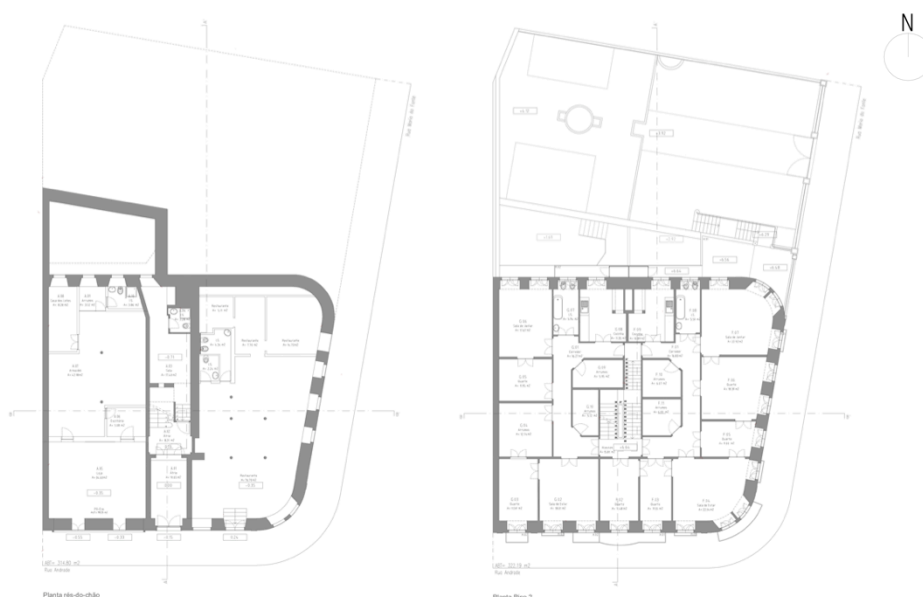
Planta rés-do-chão; Planta 2º andar (SCM, 2018).
